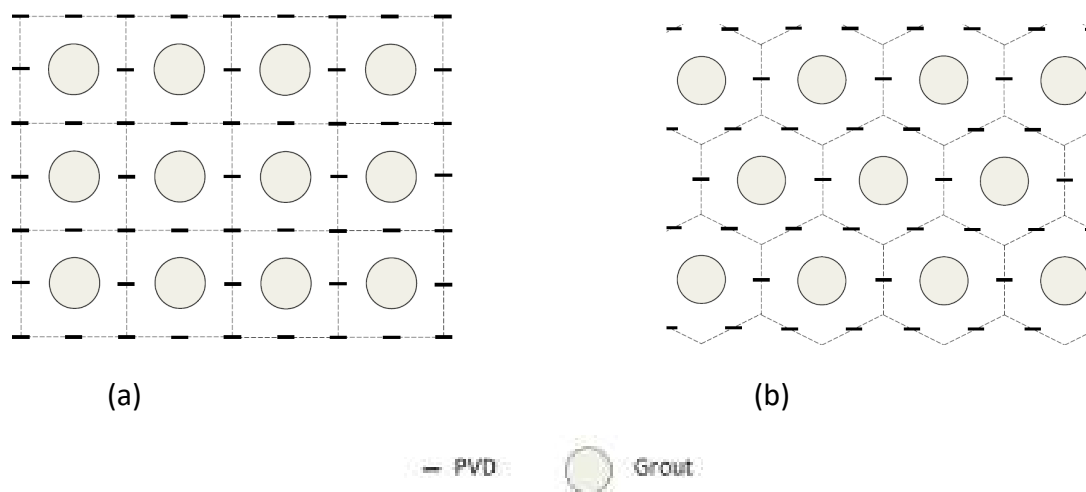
Malhas de drenos e verticais, com bulbos de compressão, normalmente utilizadas no CPR Grouting. (a) Malha quadrada com 8 drenos ao redor da vertical de geogROUT. (b) Malha triangular com 6 drenos ao redor.
